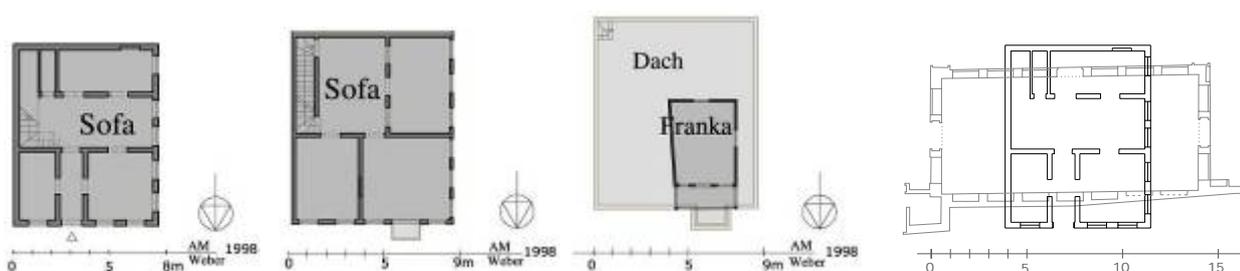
Bayt Sammān, Grundriss EG
